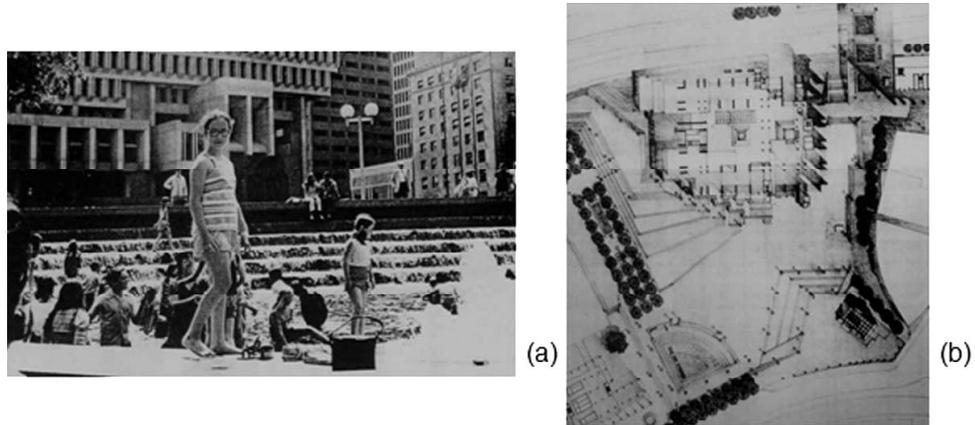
Kallman y Mckinnell, *Estanque de la plaza del ayuntamiento de Boston, Massachusetts, E.U.A (1971): (a) Vista de la fuente escalonada, (b) Planta de conjunto.
